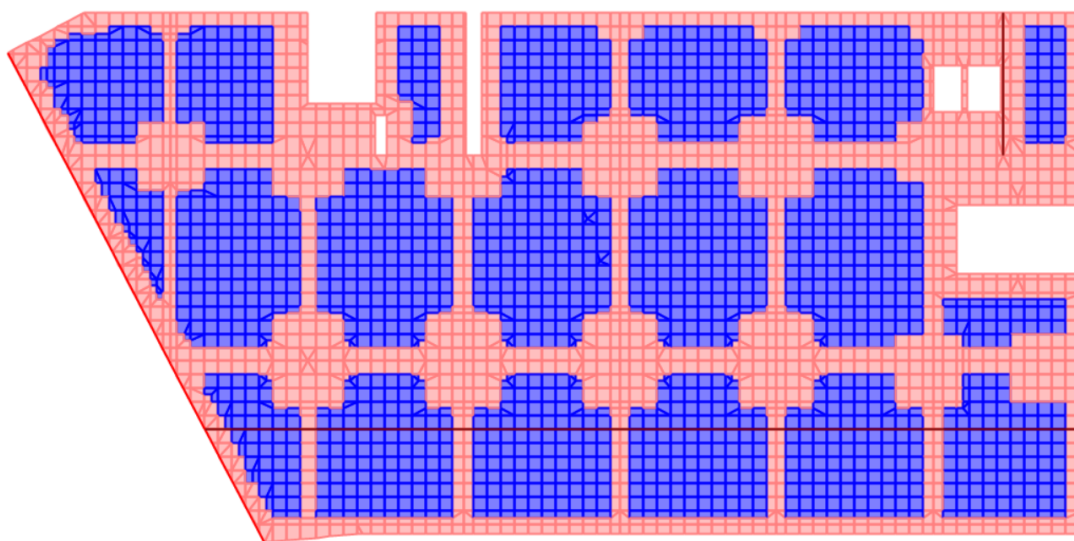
Laje do piso 1 (a vermelho zonas maciças e a azul zonas aligeiradas)
